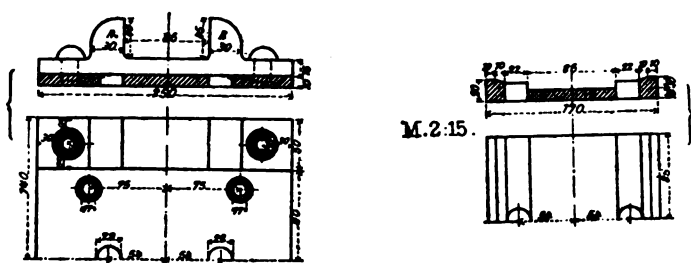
, 17, 18 e 19. — Dispositivo per il livellamento delle rotaie. Particolari delle piastrelle metalliche.
